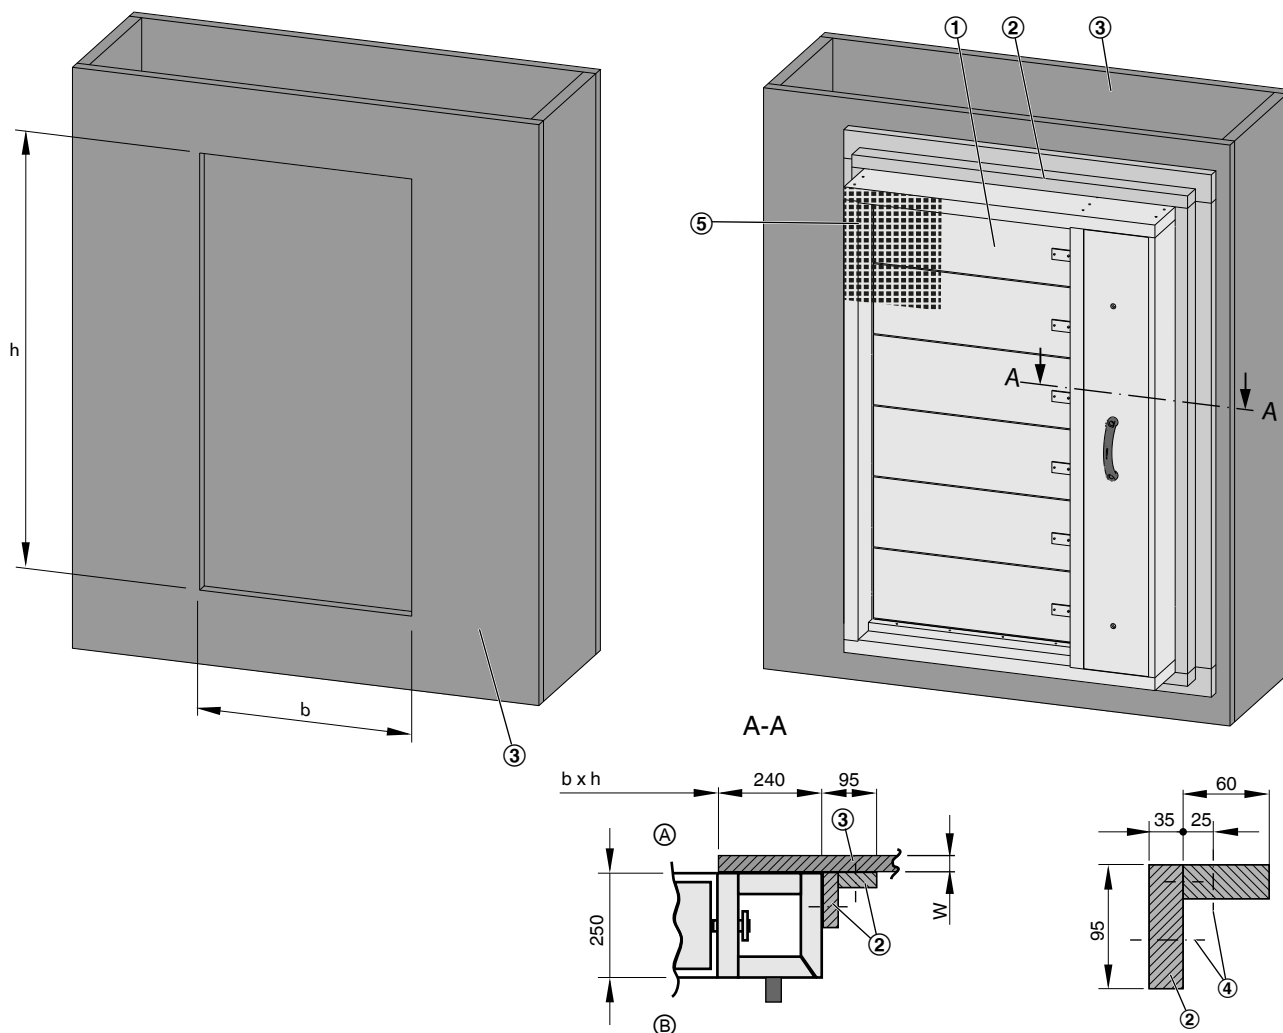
Einbau an vertikaler Entrauchungsleitung (Schacht)
